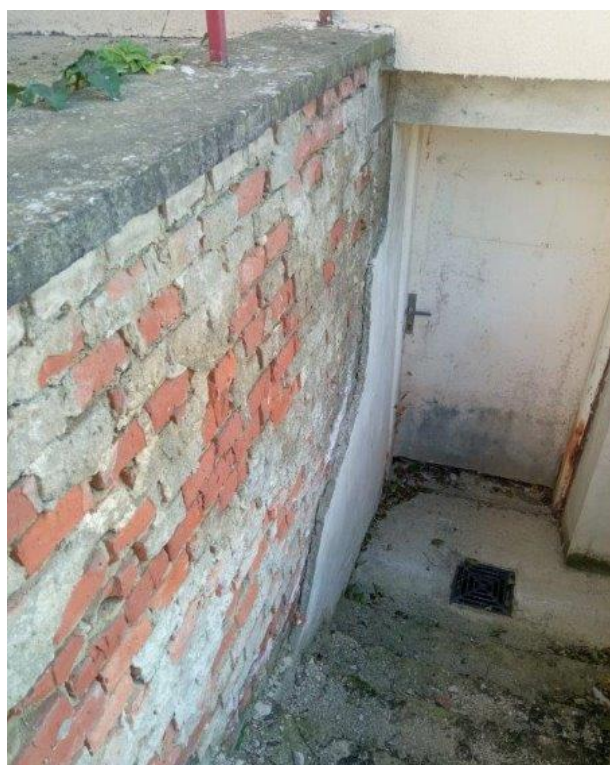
Detail stavu omítky na opěrné zdi u schodiště do suterénu zadního traktu
